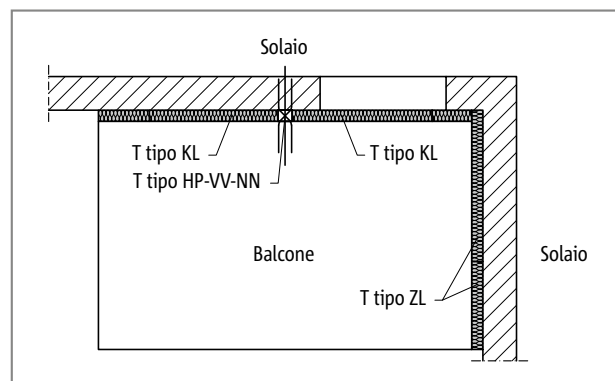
Schöck Isokorb® T tipo HP: balcone a sbalzo
